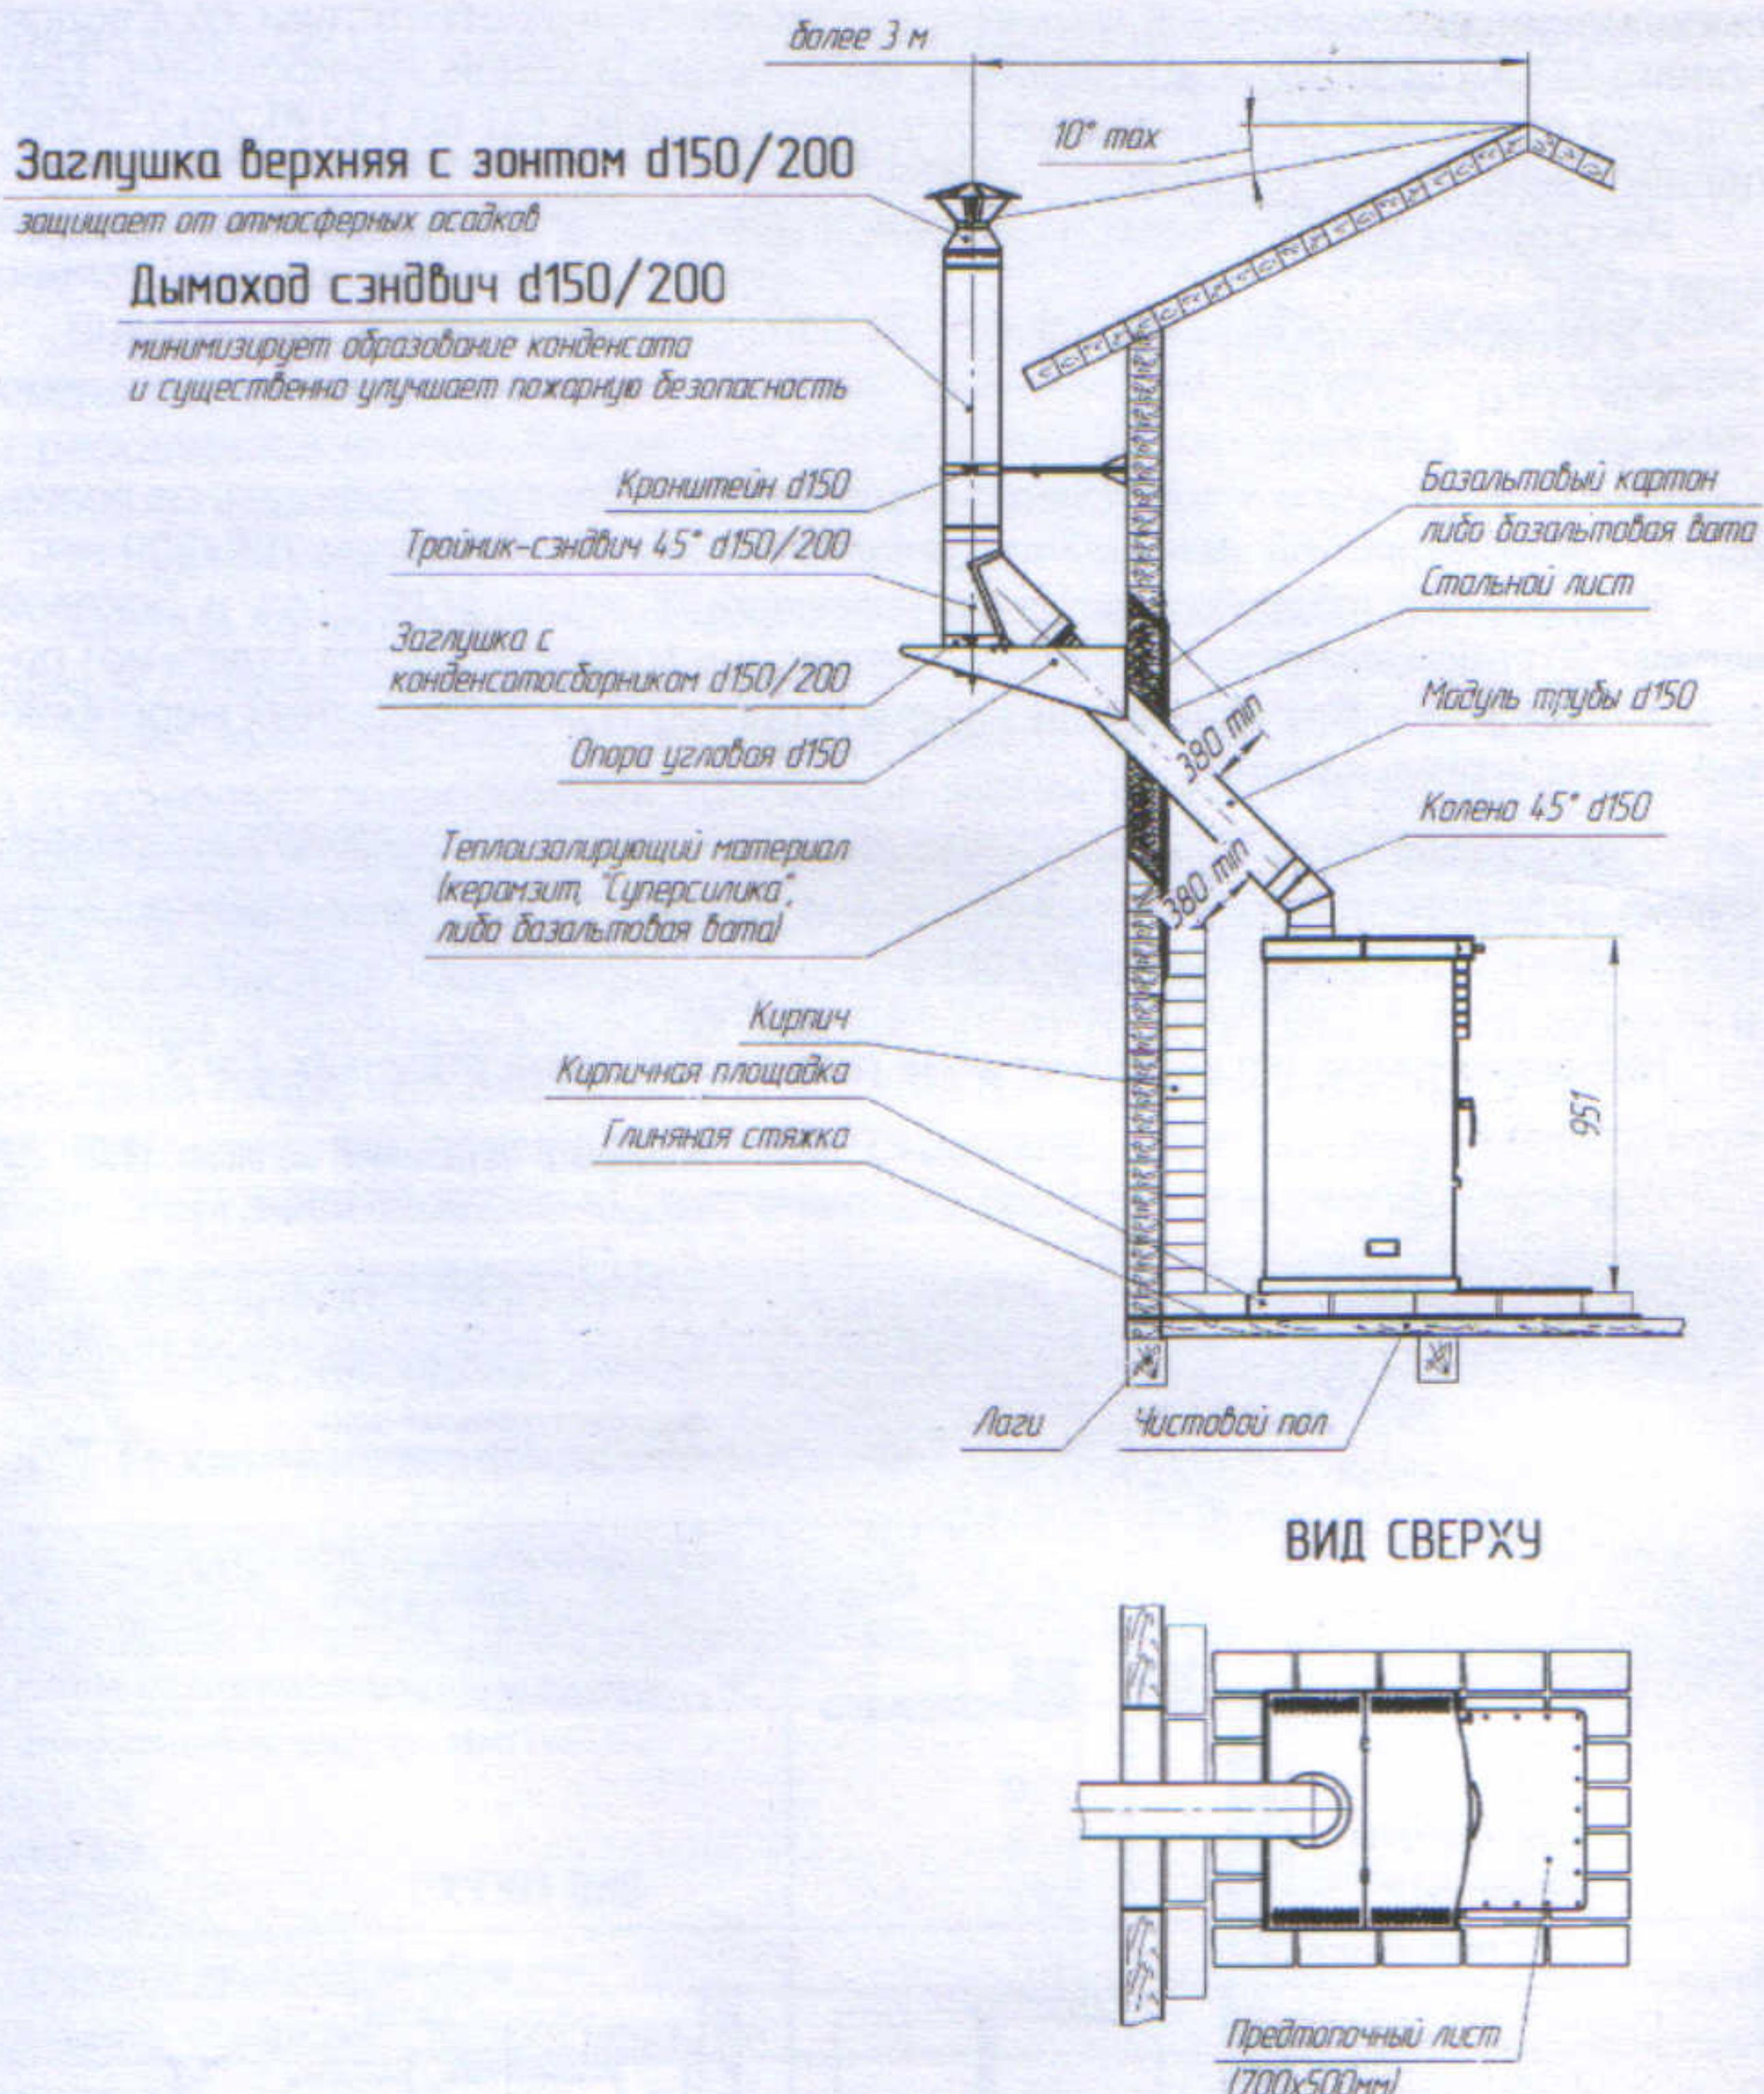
Схема установки камина при монтаже дымохода снаружи здания
